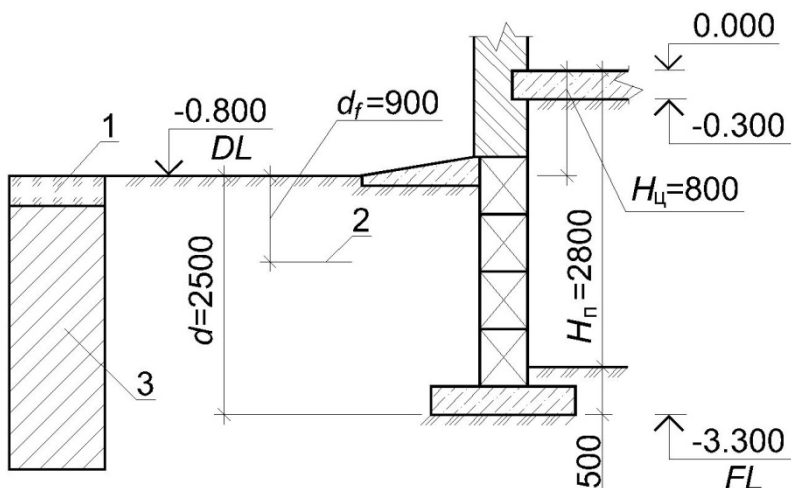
Схема к назначению глубины заложения подошвы фундамента (пример 4.2):
